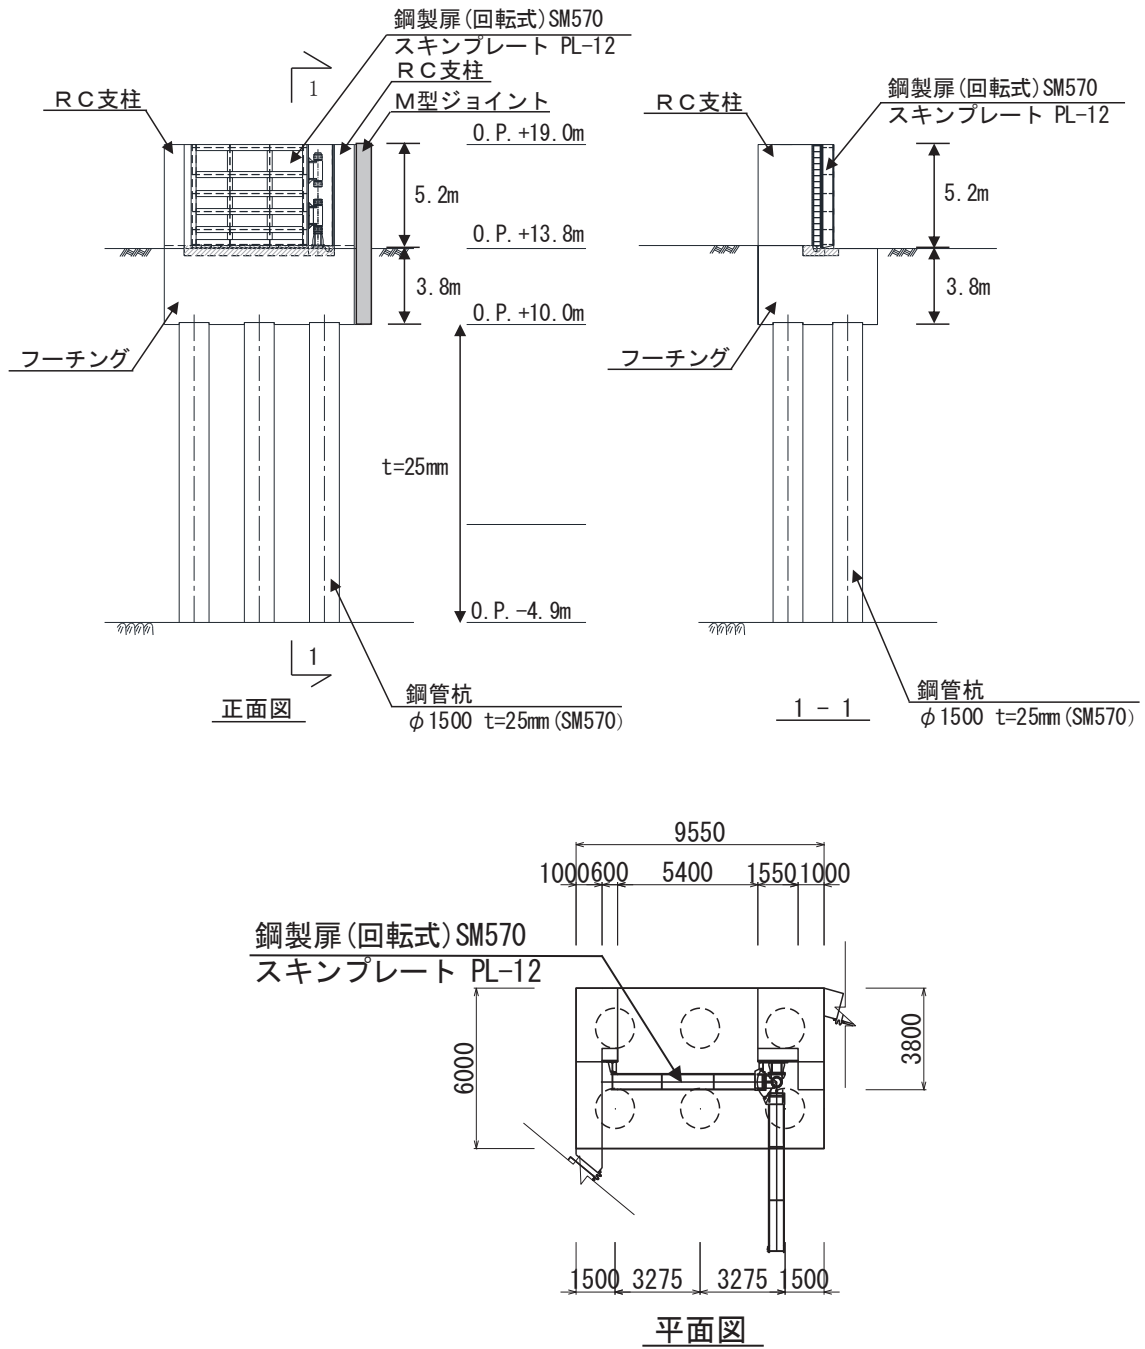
鋼製扉 2 の構造図 (正面図及び断面図, 平面図)
